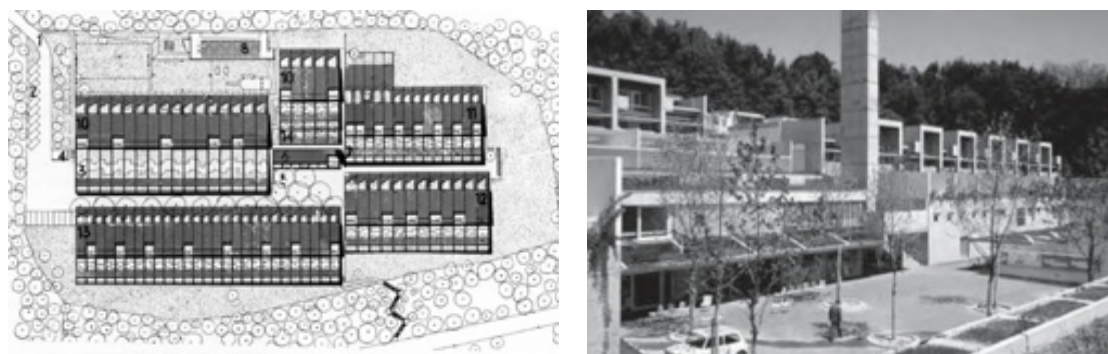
Planta de Implantação e Vista sobre a praça comunitária de Halen.
